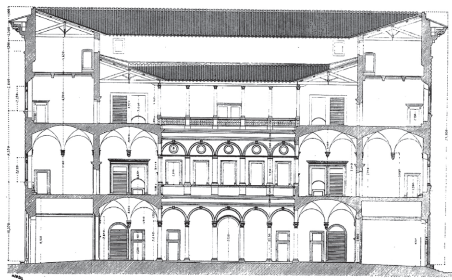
Benedetto Da Maïanao. Palais Strozzi (Florence) Largeur du palais : 13 travées du portique
